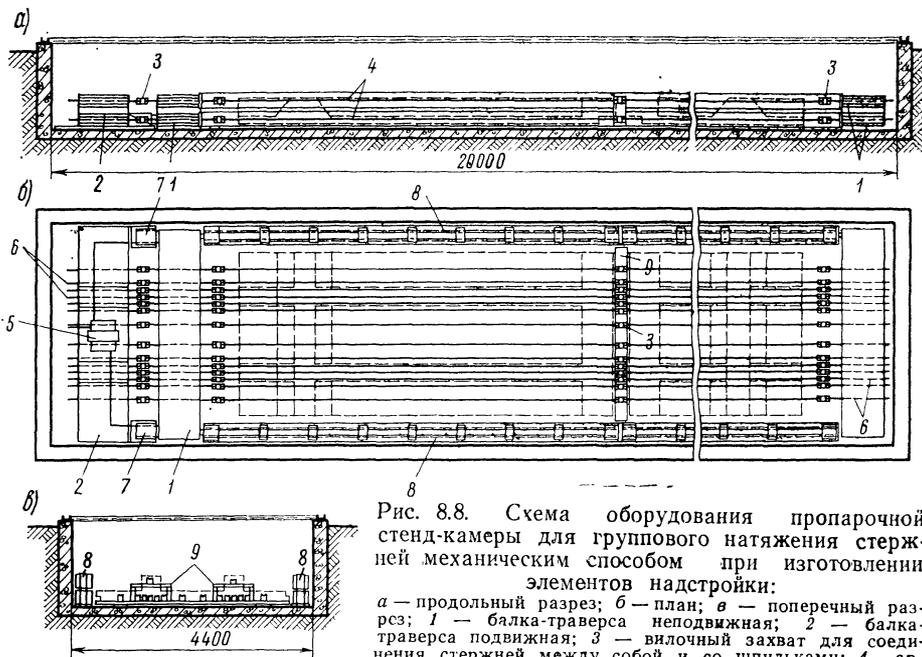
Схема оборудования пропарочной стеновой камеры для группового натяжения стержней механическим способом при изготовлении элементов надстройки:
